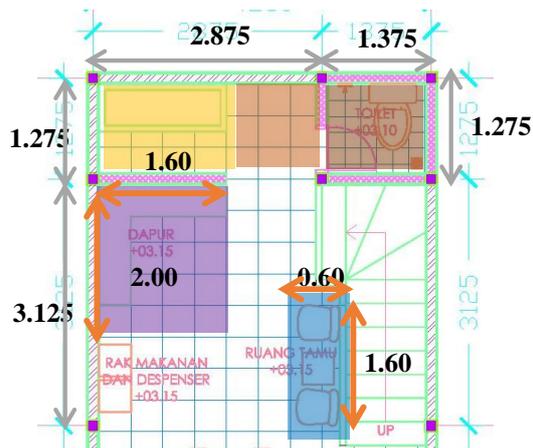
Denah Ruang Servis Lantai 1 Objek B
